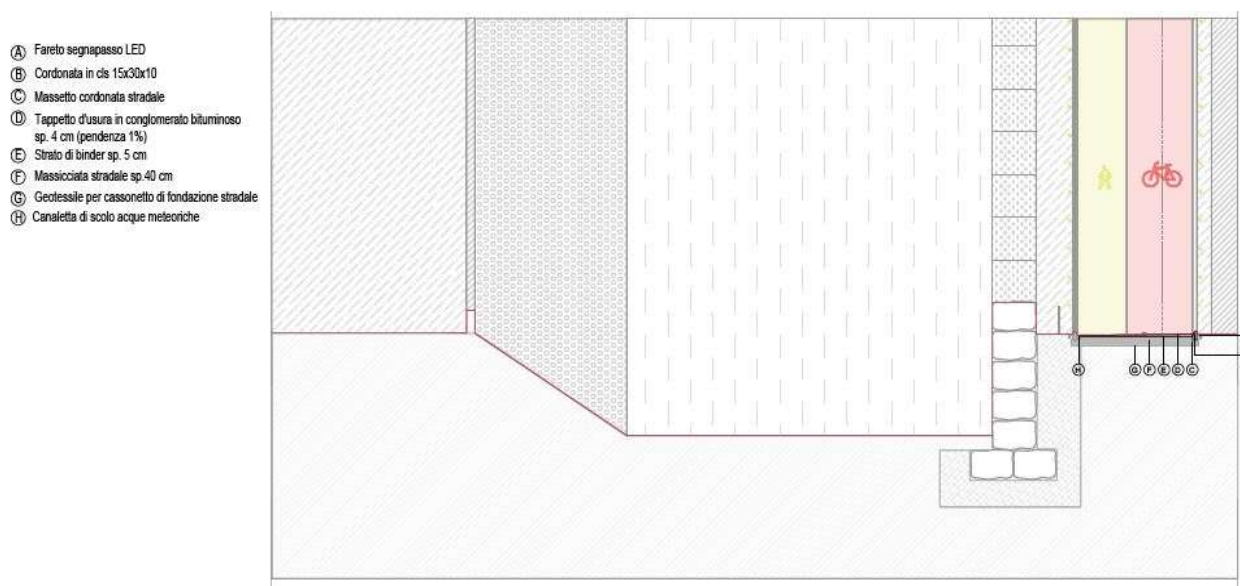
Esempio pista ciclabile di progetto - dx Idraulica Rio Seligheddu – pianta/sezione
